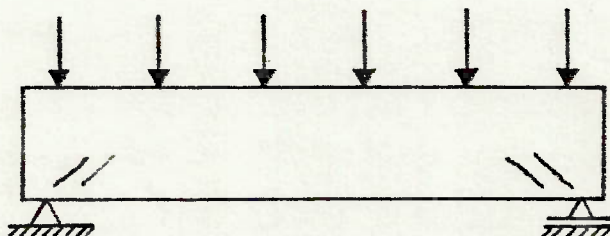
Trincas de cisalhamento em viga solicitada à flexão
